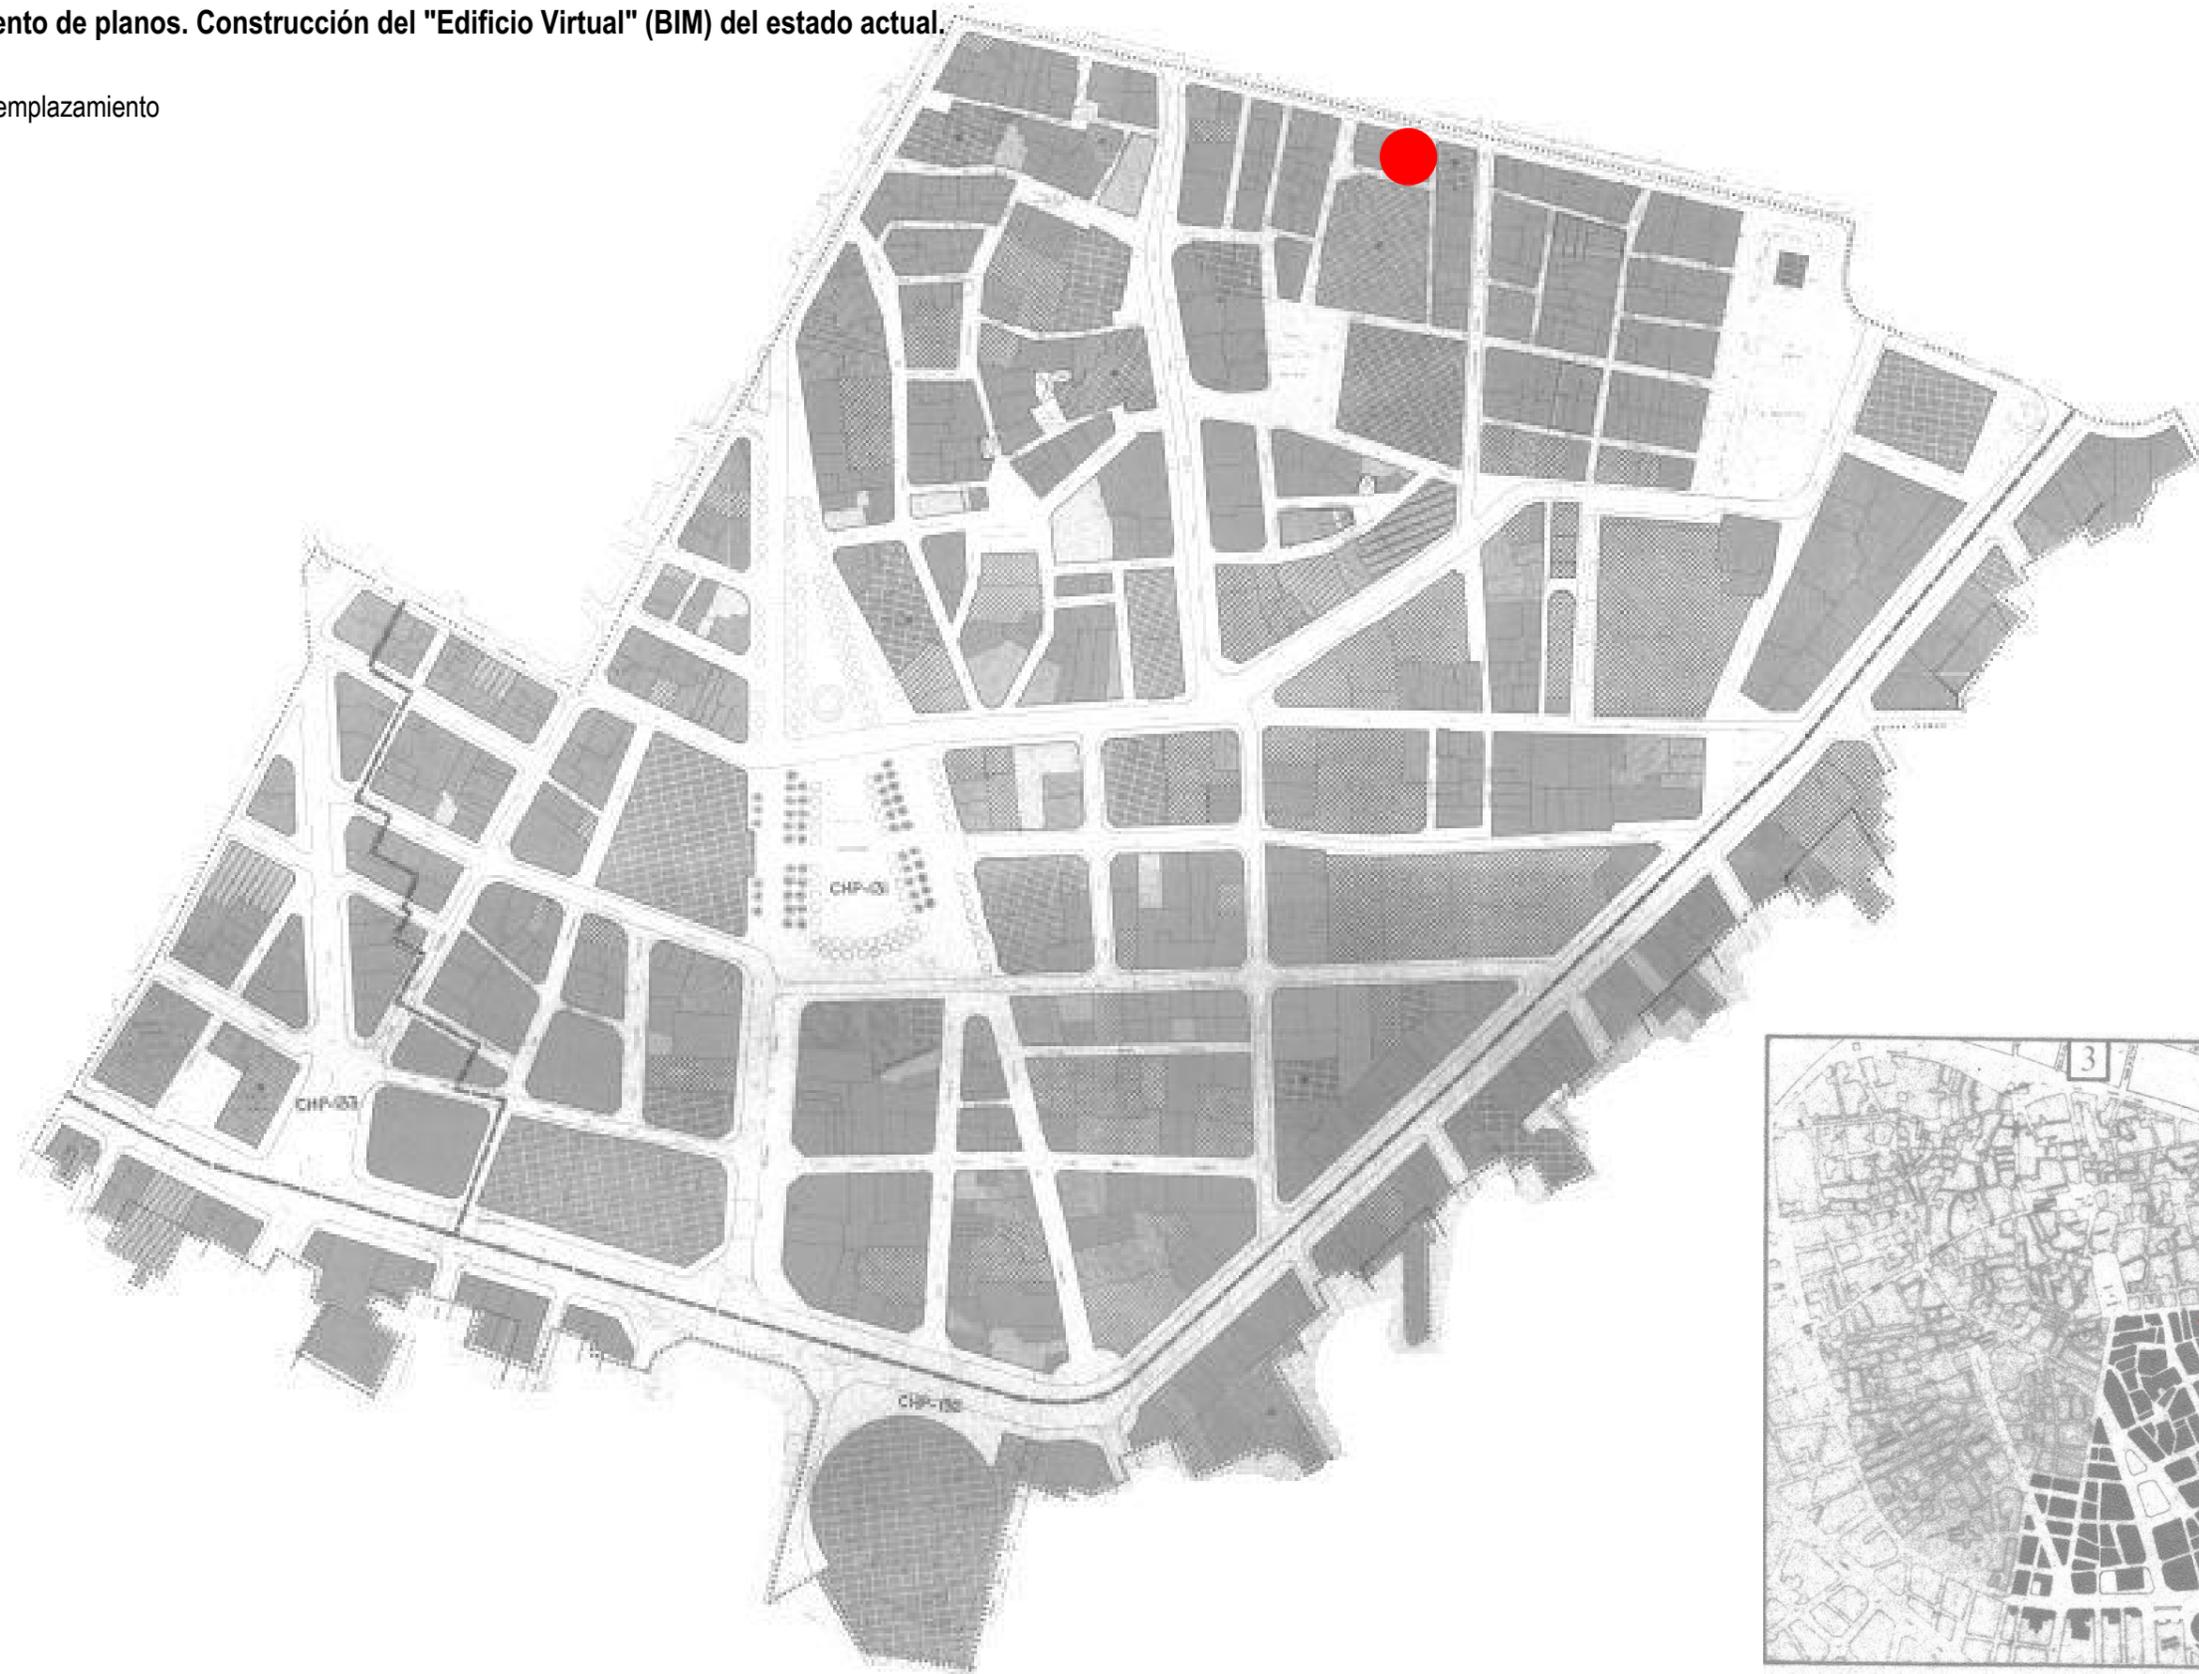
Plano de situación Barrio Universitat - San Francesc.
